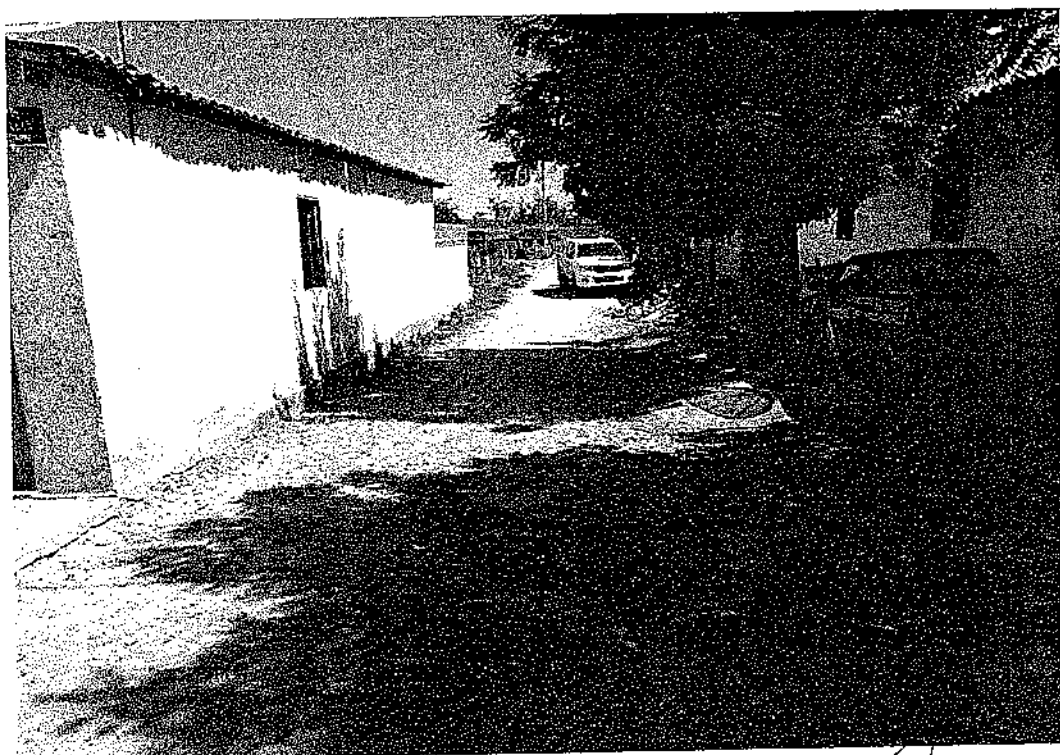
Travessa A – Bairro Expedito Diogenes . Coordenadas : 542095 / 9350167
